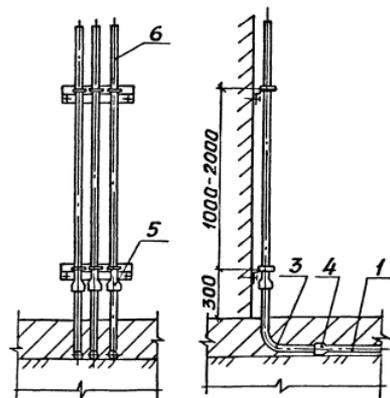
Прокладка труб из ПВХ без защиты от механических повреждений\
